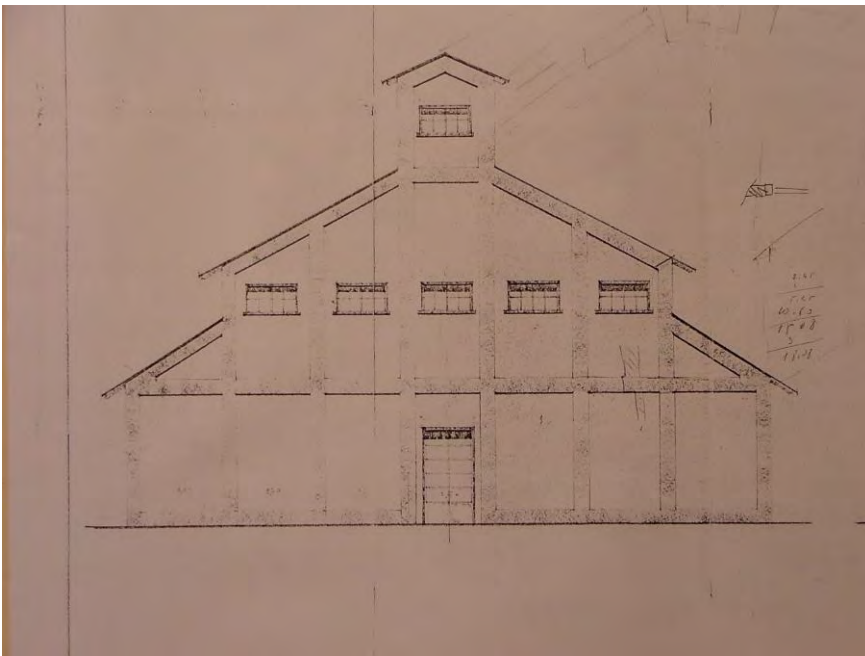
Progetto Nervi, prospetto frontale, 1954
